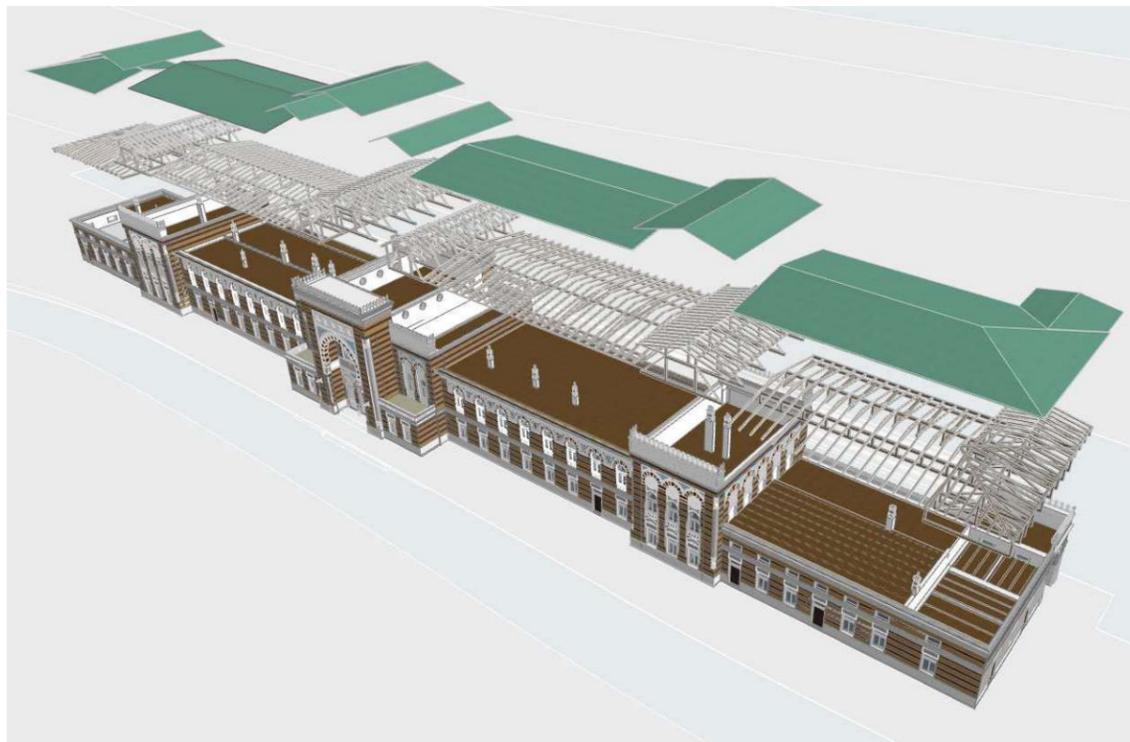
Explosions-Darstellung des Dachstuhles und Dachaufbaus, Modelldarstellung
